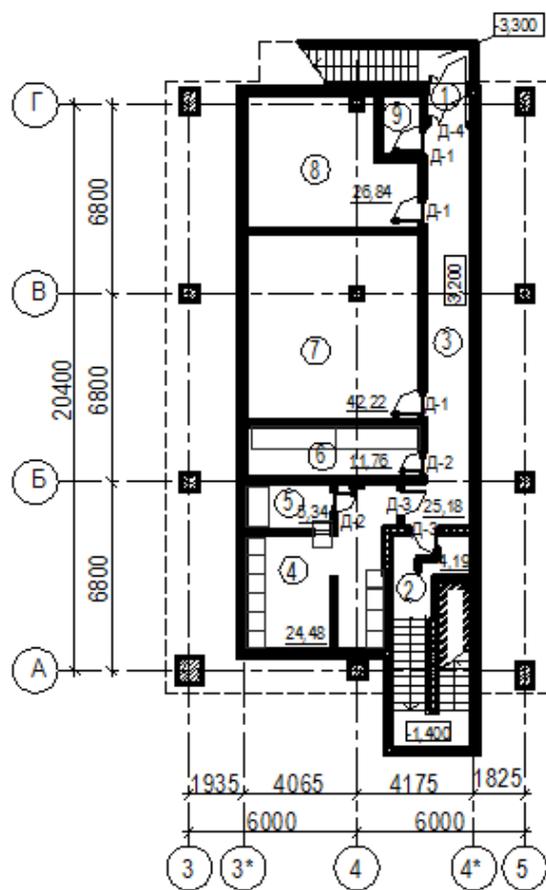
План подвального этажа на отм. -3,200 м
